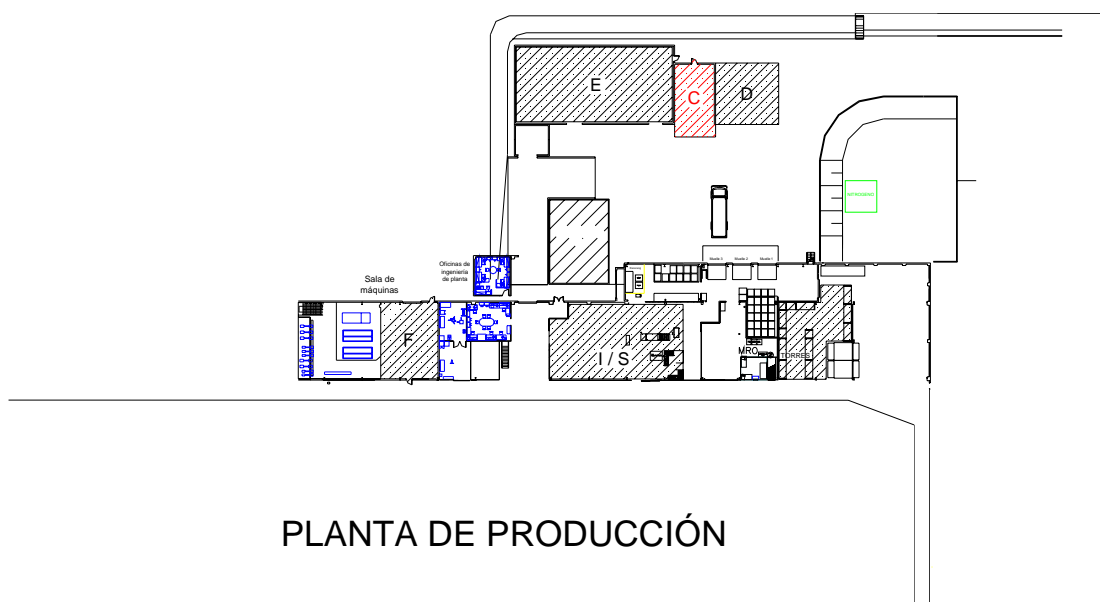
Vista en planta de la ubicación del almacén de cartón.
